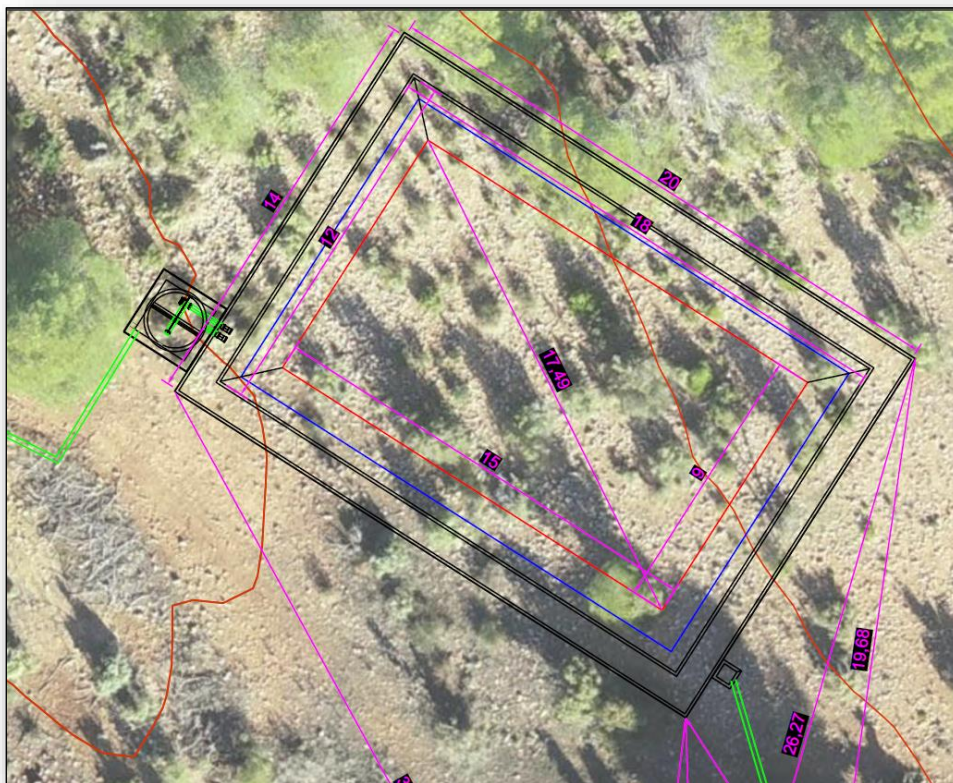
Vista en planta dimensiones de humedal. (Ecolagunas.2022)
